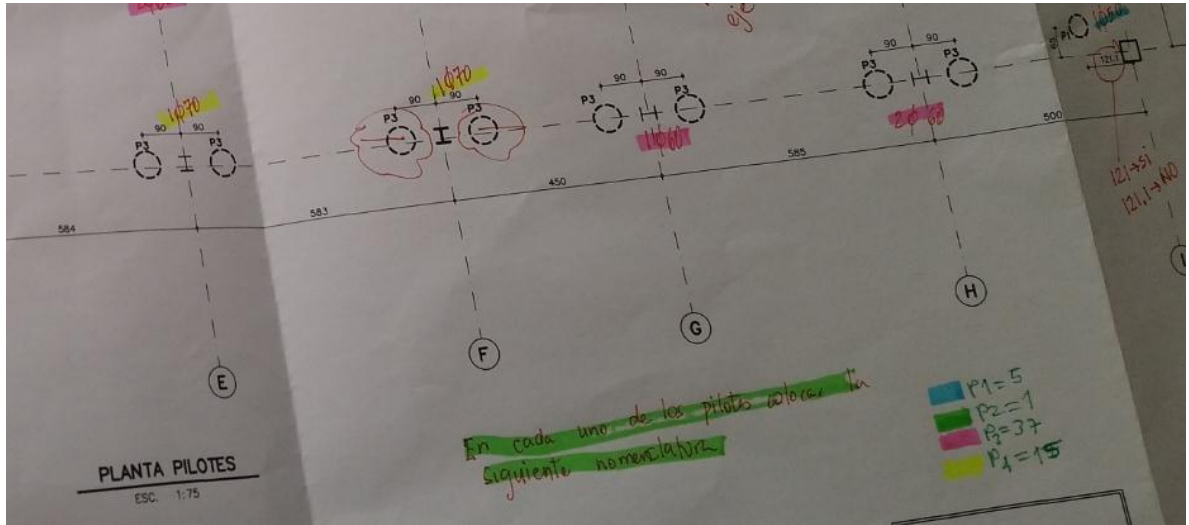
PLANTEAMIENTO FINAL DE PLANTA DE PILOTES.
